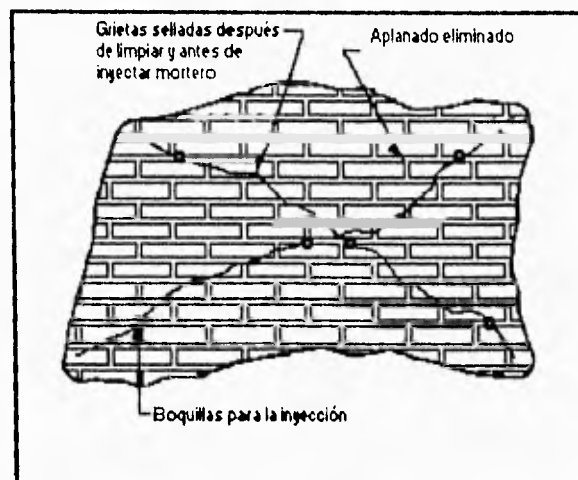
INYECCION DE GRIETAS EN MUROS DE MAMPOSTERIA
